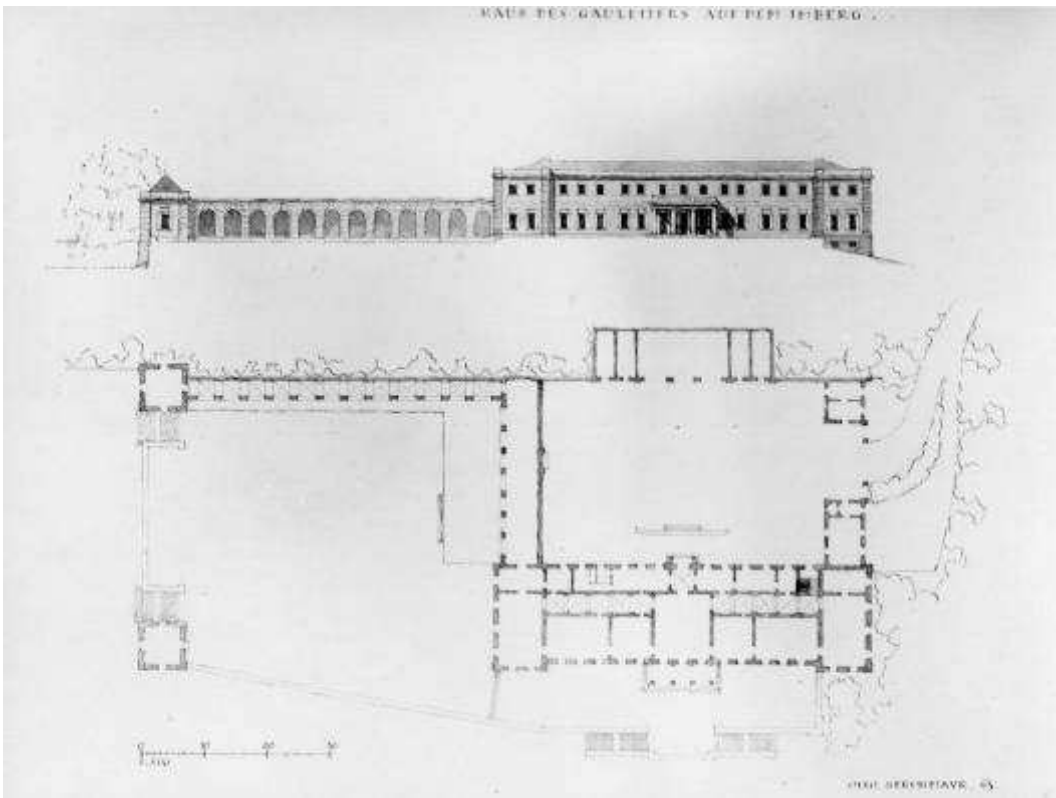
Otto Strohmayer, Ansicht und Grundriss, Haus des Gauleiters, Imbergverbauung, Salzburg, 1943 (Sammlung Fais-Månsson).
